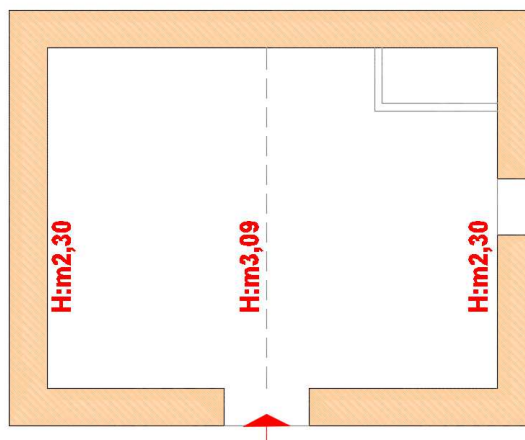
Planimetria del fabbricato ricadente sulla p.lla 173
